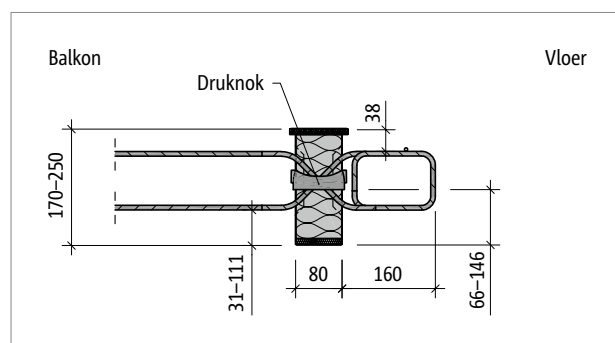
Schöck Isokorf® T type Q-E-V7: Zijaanzicht
